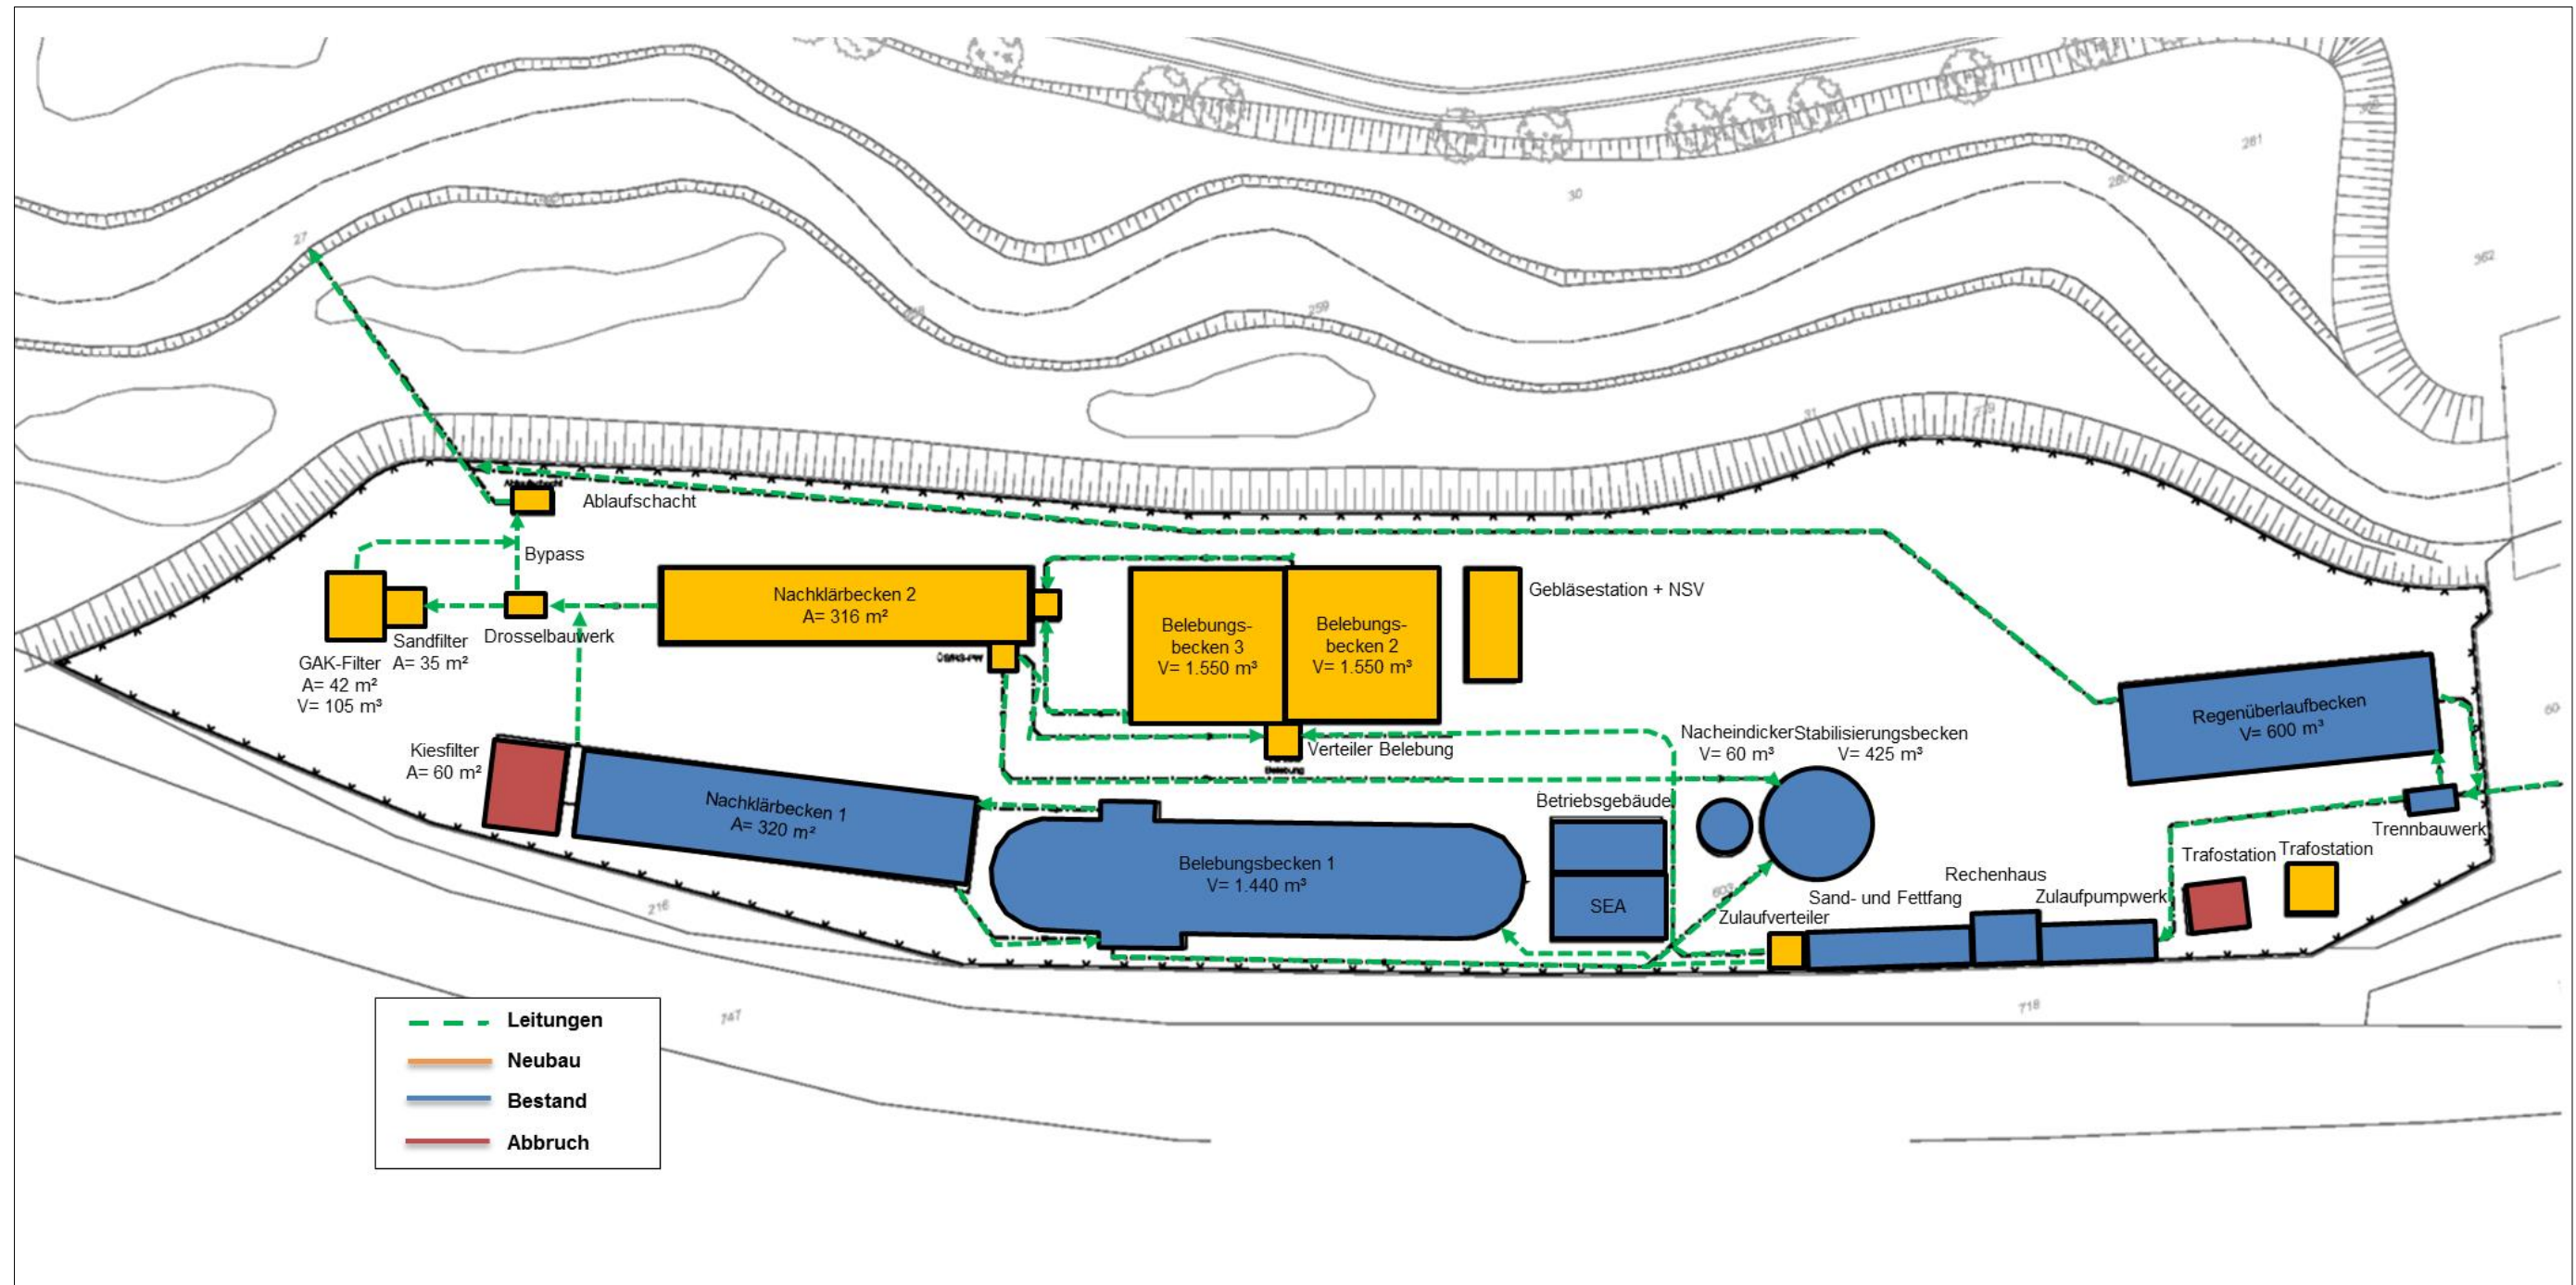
Lageplan - Variante 3; Maßstab 1:750
